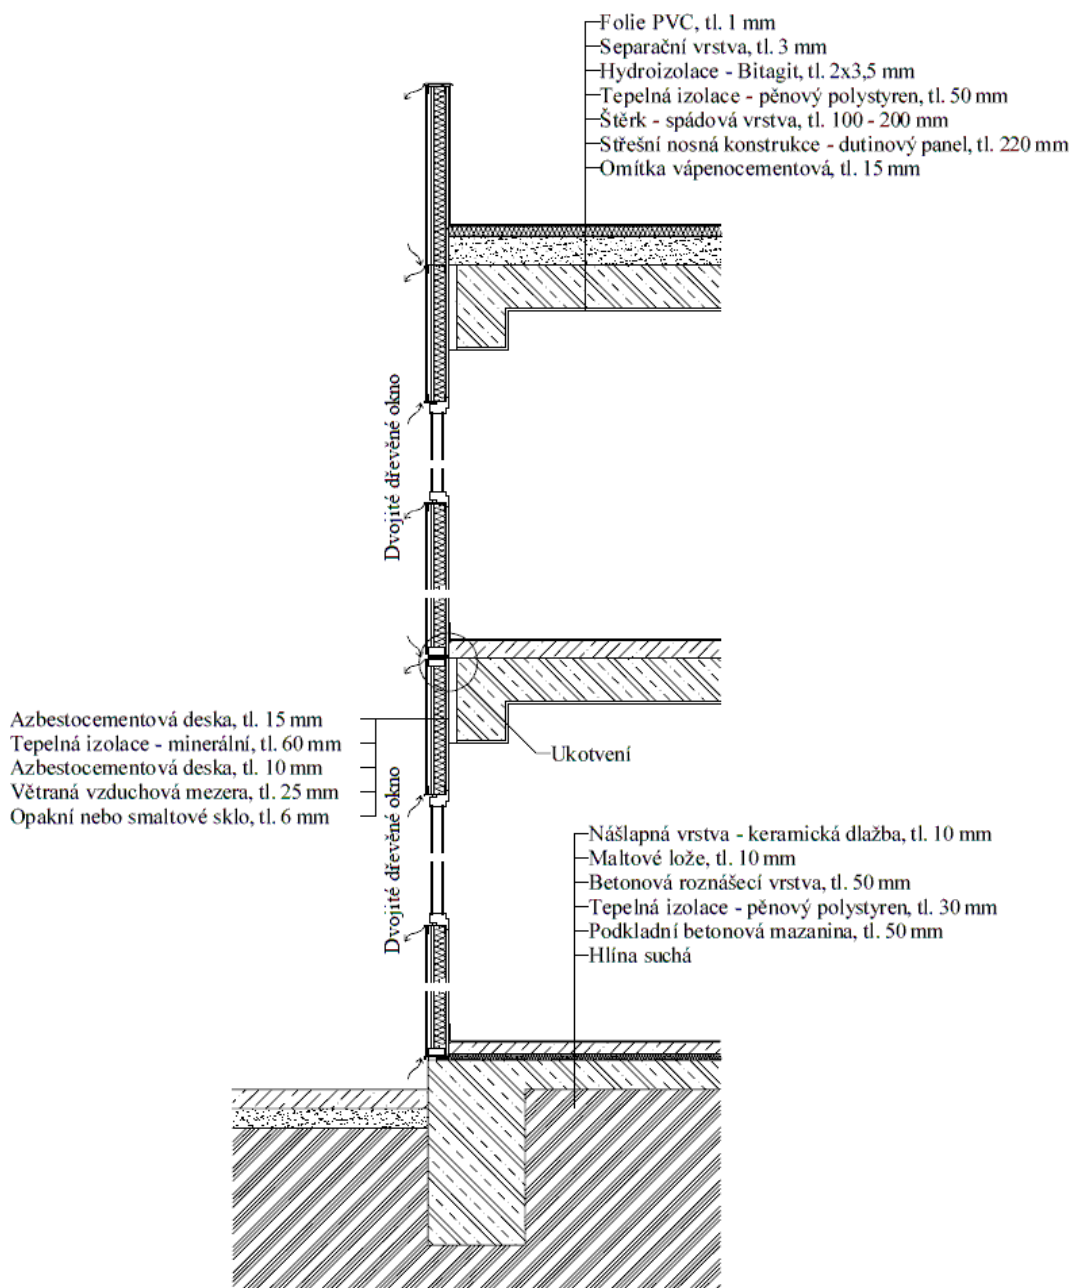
Původní konstrukce OD-001 „Boletický panel“
